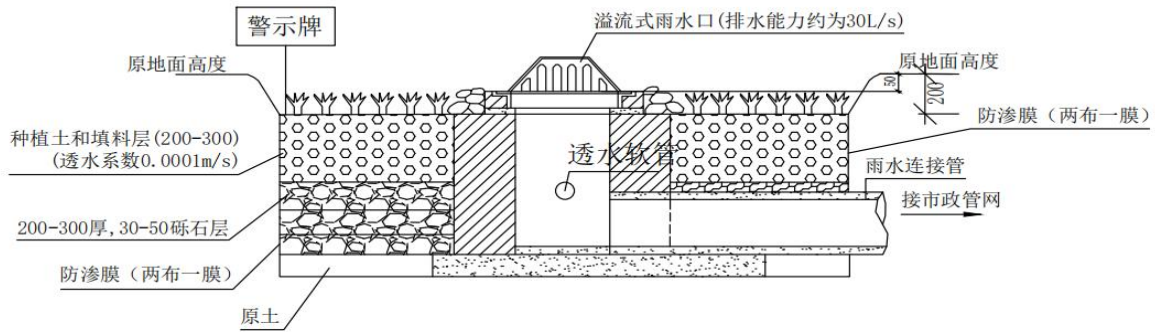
下沉式绿地典型断面图（单位：mm）
